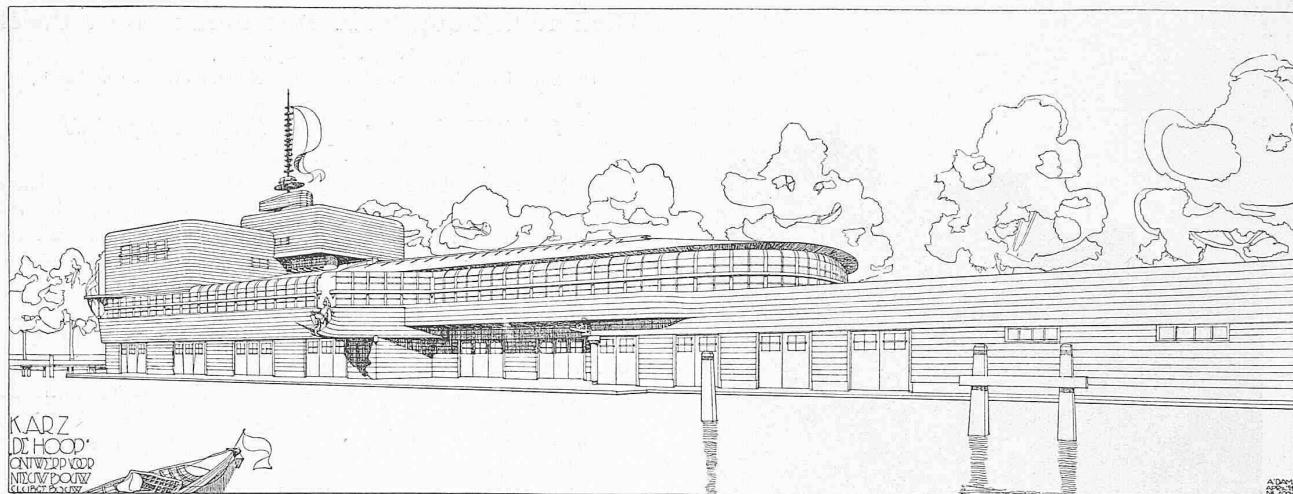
Klubhaus der Amsterdamer Ruder- und Segler-Vereinigung (Wasserseite). Architekt M. de Klerk (1922). Holzbau, unten Bootsschuppen, darüber Gesellschaftsräume (vergl. Grundriss Abb. 37). Der Entwurf entfaltet sich in einer vom Innern ausgehenden, das ganze Gebäude umspielenden Bewegung, die sich der Ankunftsrichtung der Boote entgegenstellt.
